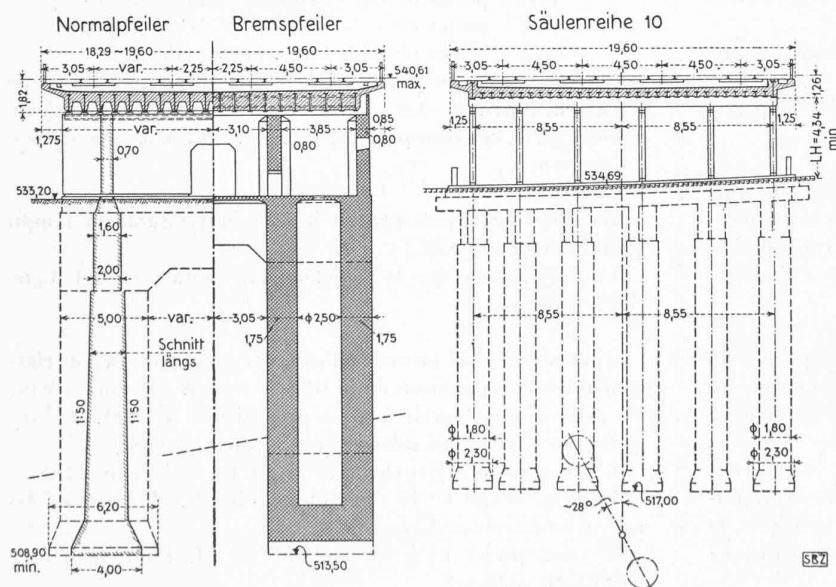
Divers types de construction du lot 5. (La profondeur des fondations est variable) Echelle 1 : 400. La fondation de la pile supportant l'effort de freinage est formée, à partir de la cote 535 environ de 8 puits Ø 1,8 m. Pile normale. Pile de freinage. Série de colonnes 10.
